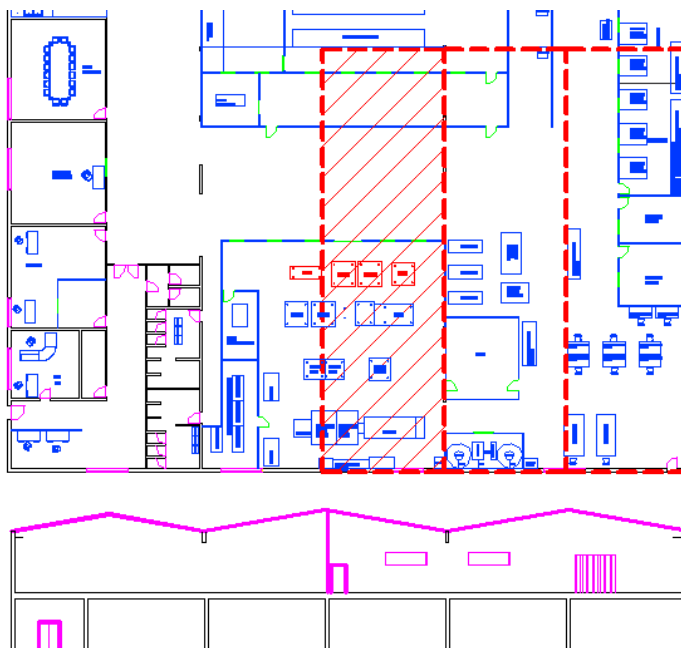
| Planta parcial do piso e corte do armazém, com a localização da laje e do painel analisado
